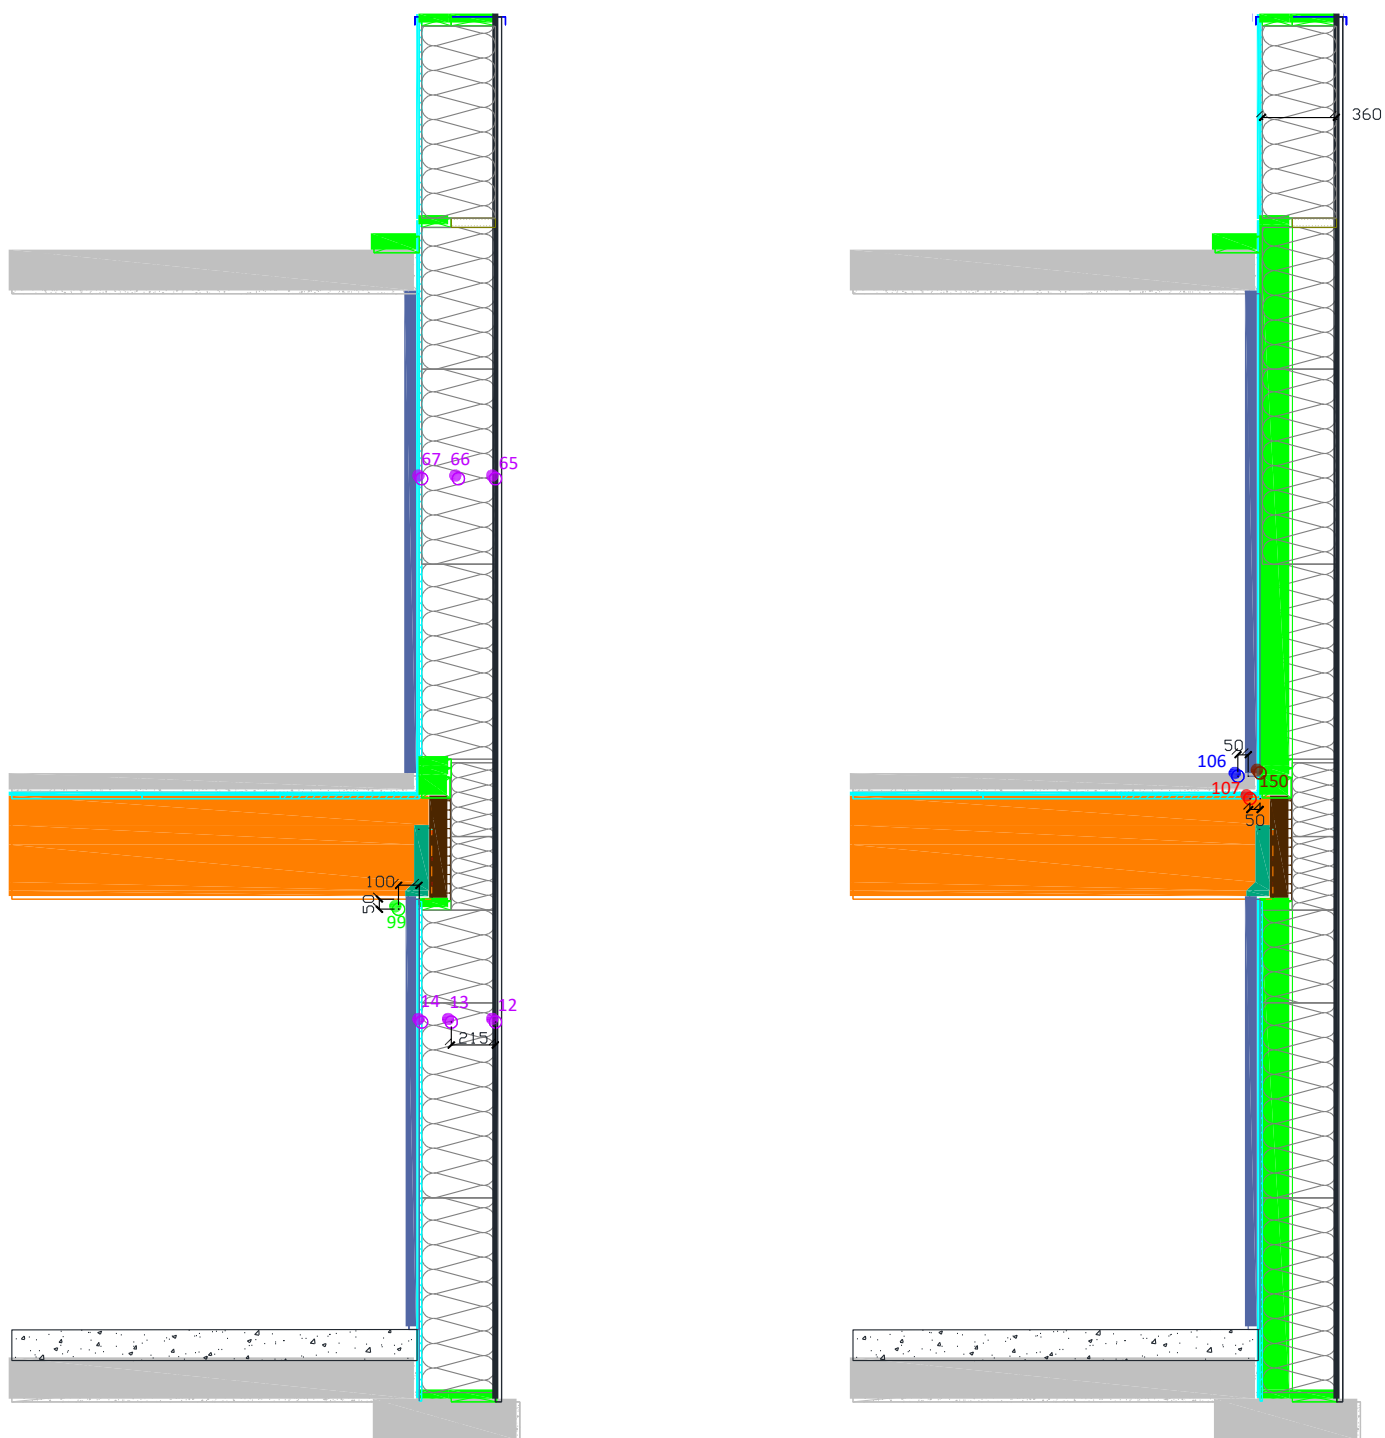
Instrumentation de l'élément de façade - (A gauche) : Coupe E-E - (A droite) : Coupe F-F
